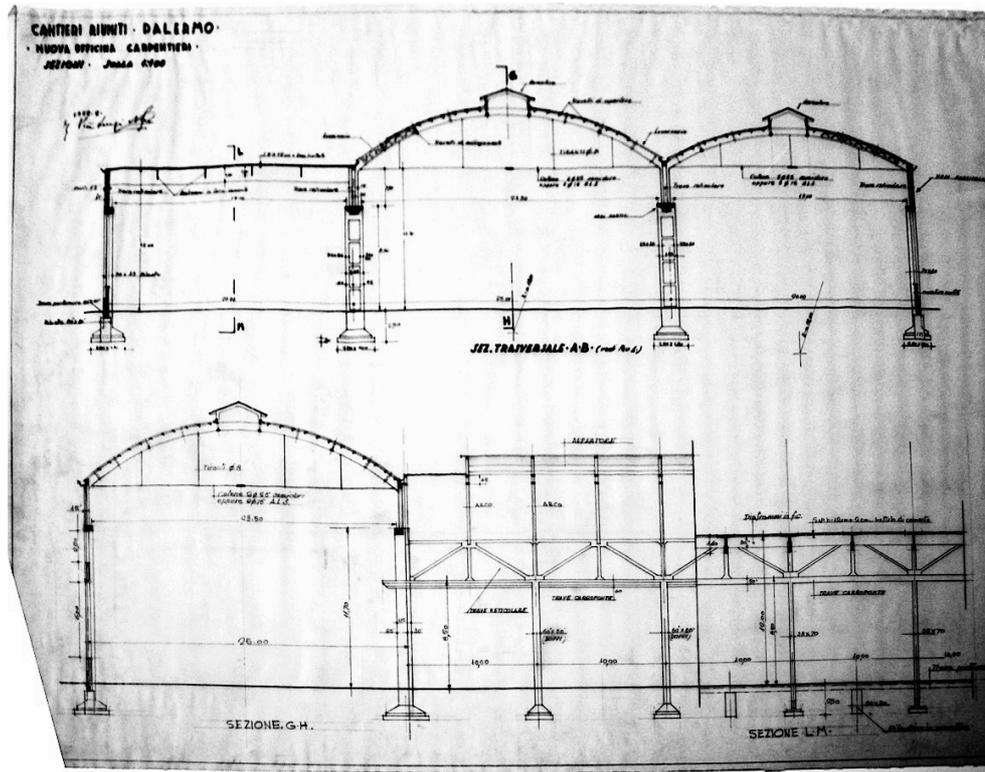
Sezioni trasversale e longitudinale e particolare Offina Carpentieri Palermo, CSAC Fondo Nervi
